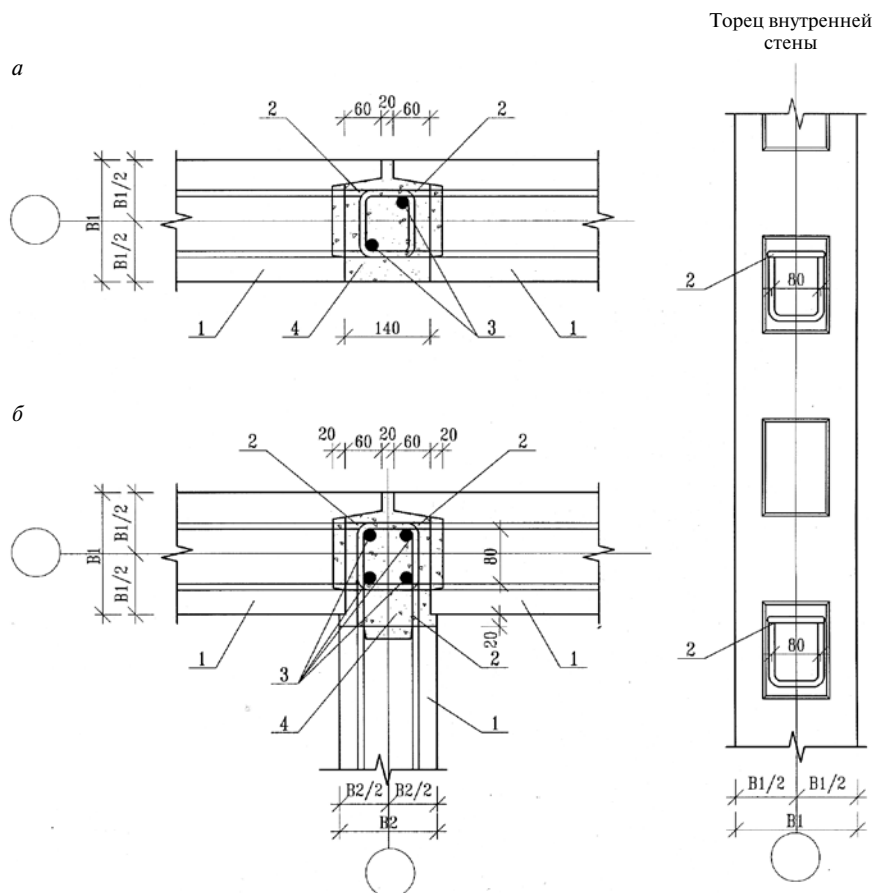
Монтажные узлы внутренних панелей с петлевыми выпусками из обычной арматуры: а – два соединяемых элемента; б – три соединяемых элемента; 1 – внутренняя стеновая панель; 2 – арматурный петлевой выпуск; 3 – арматурные стержни (по расчету); 4 – мелкозернистый бетон кл. В25–В40
